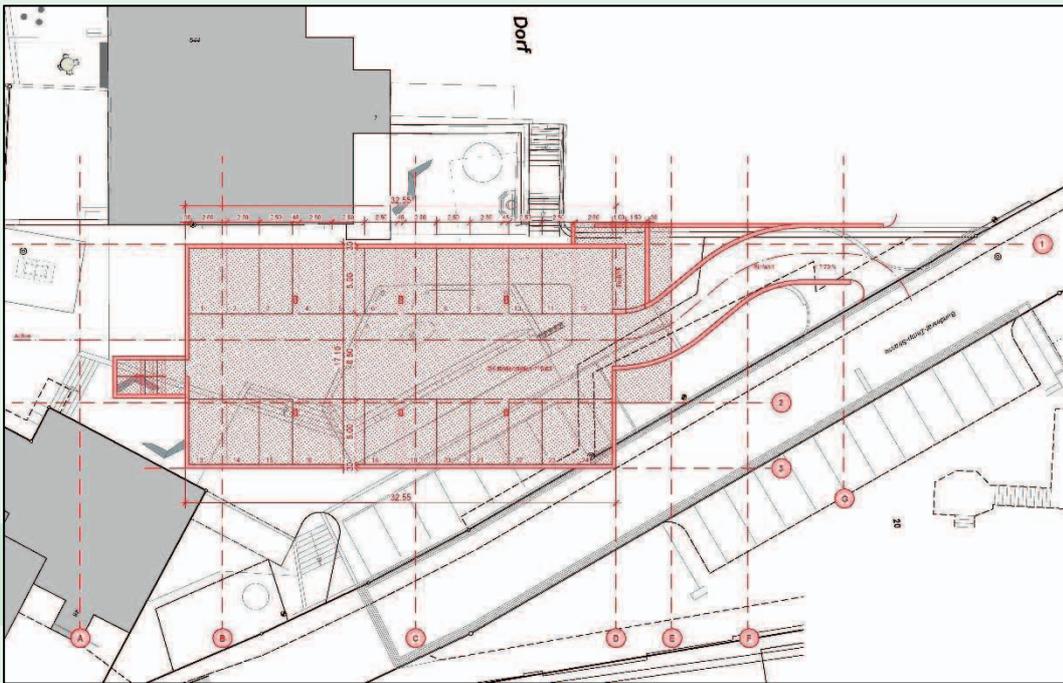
Erschliessung Einstellhalle Pfrundmatt (ohne Massstab)
